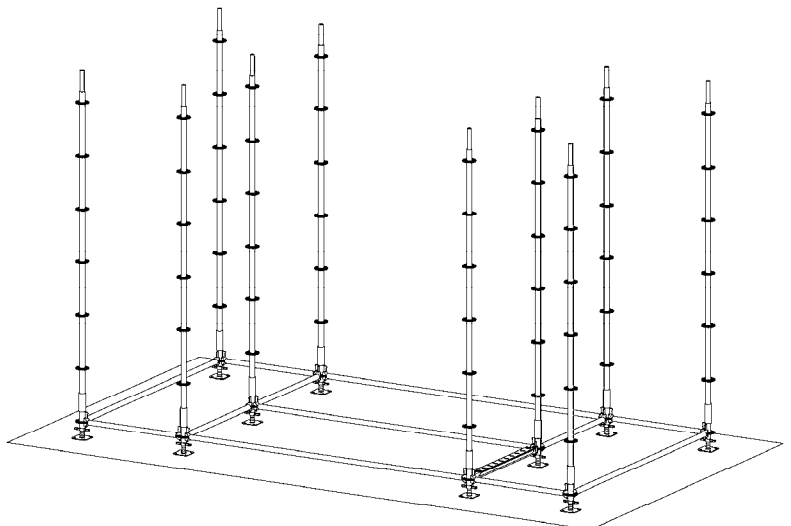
Grundrahmen der baurechtlich notwendigen Treppe
